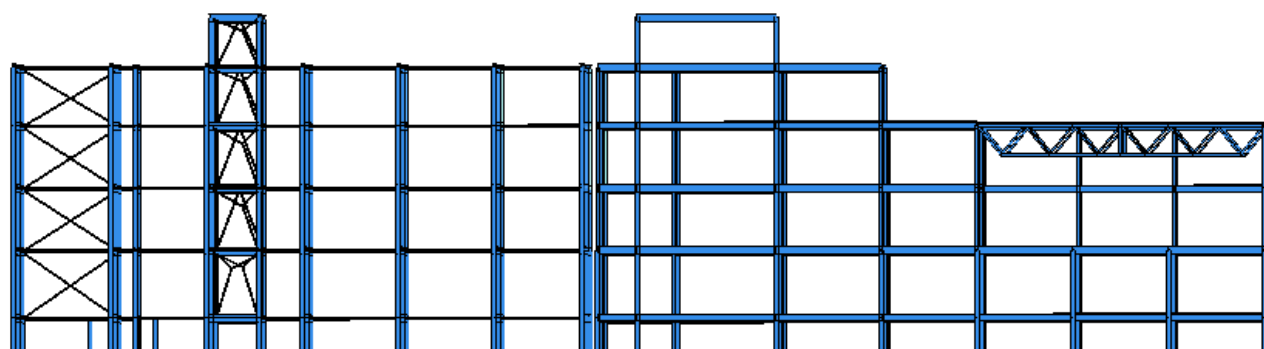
Расчетная схема 3D, поперечный разрез
